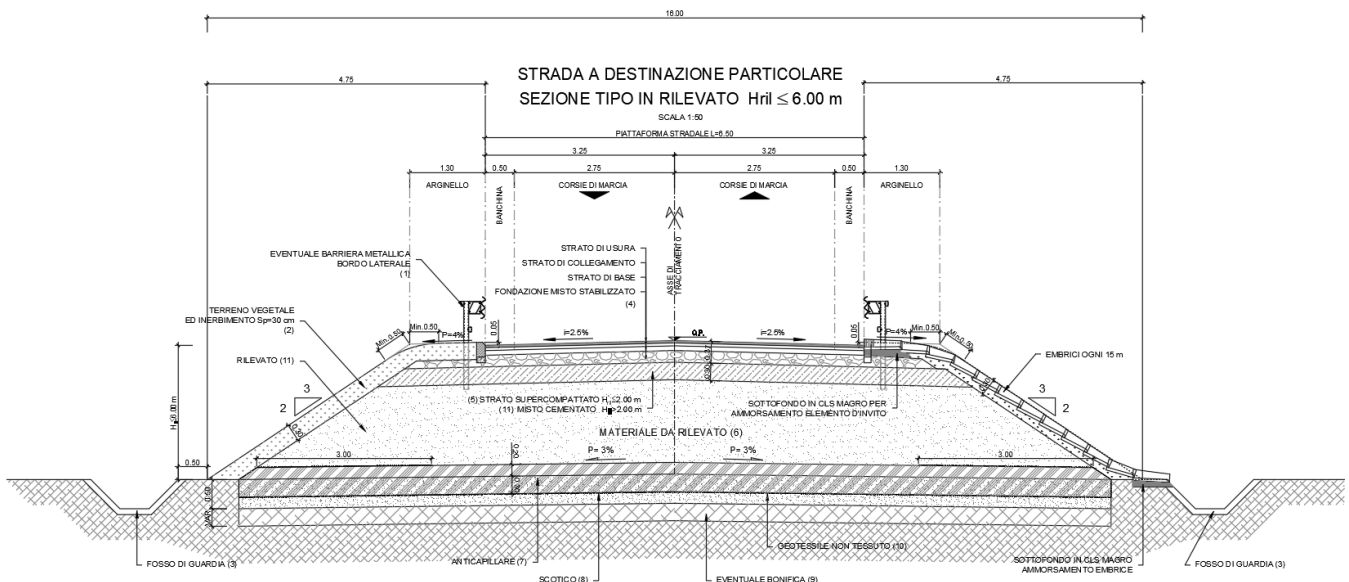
Sezione tipo piattaforma stradale in rilevato.
